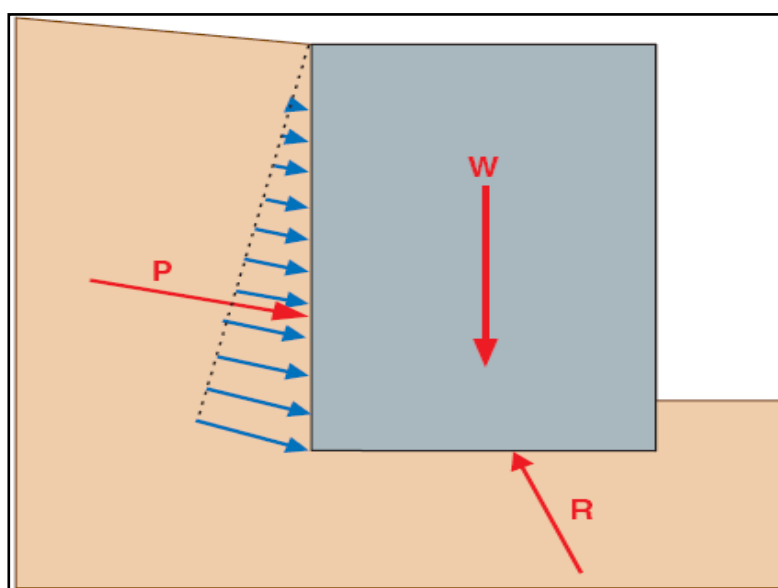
Stabilité externe d'un mur de soutènement en terre armée
